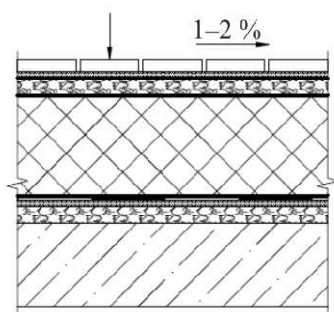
Поперечный разрез инверсионной кровли с покрытием из тротуарной плитки
